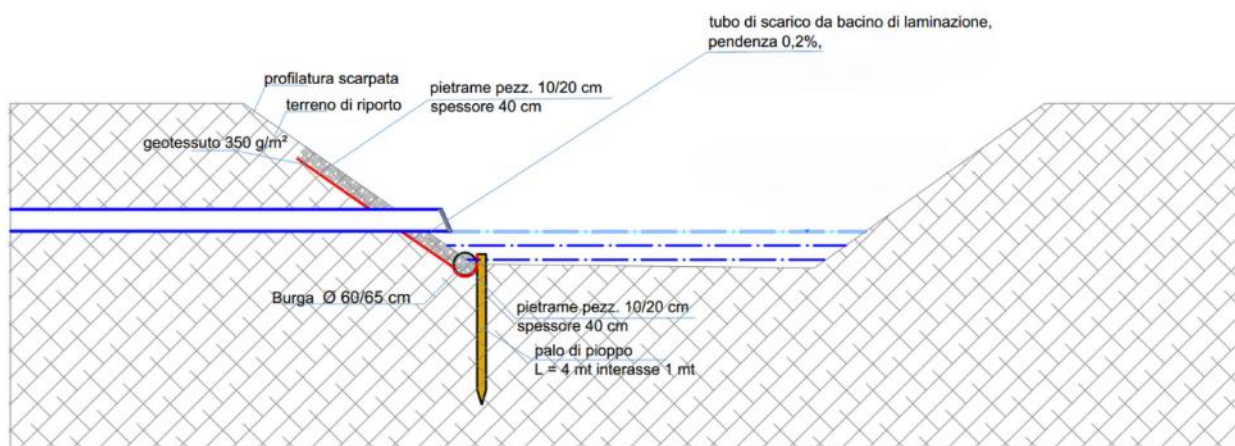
Sezione tipologica punto scarico e protezione spondale
